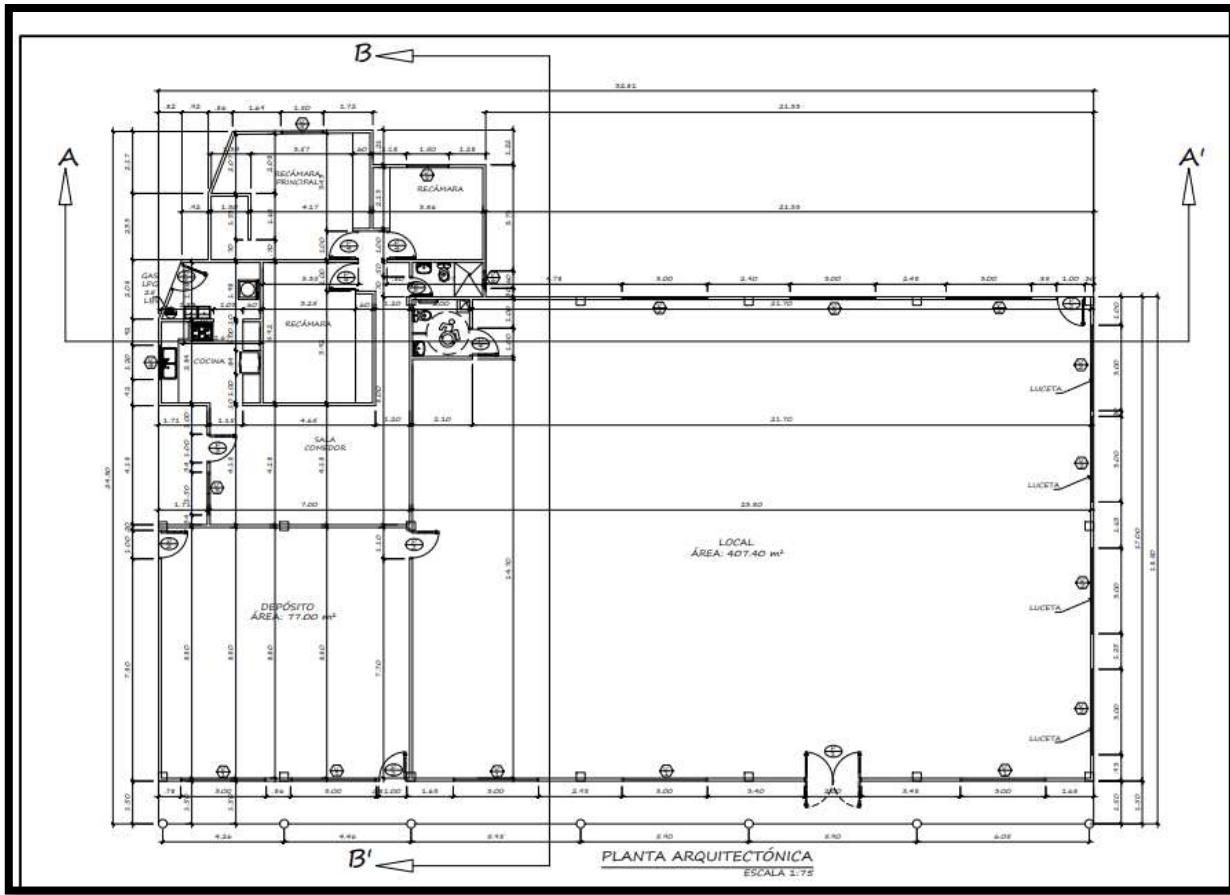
Plantas arquitectónicas del proyecto. Fuente promotor
